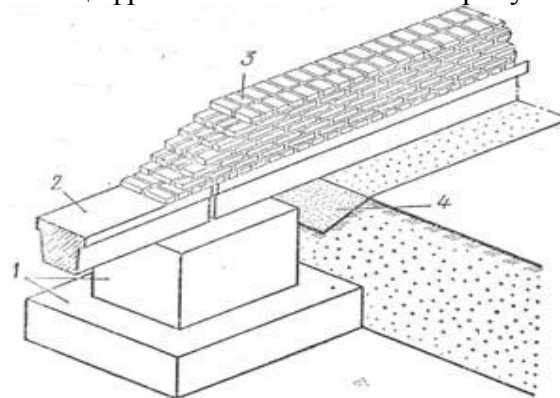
Узел опирания несущей стены здания на столбчатый фундамент
